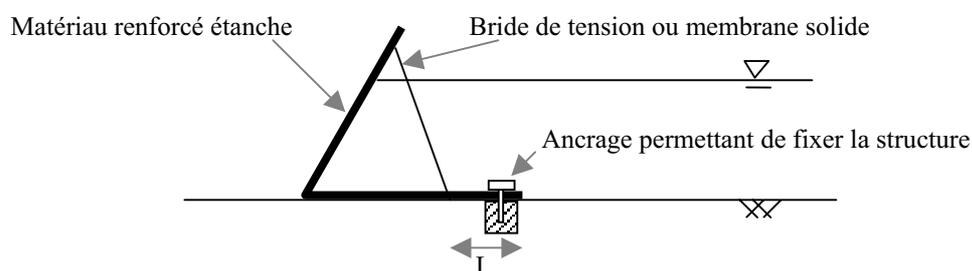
Schématisation de la variante de batardeaux avec fixations permanentes dans la fondation
